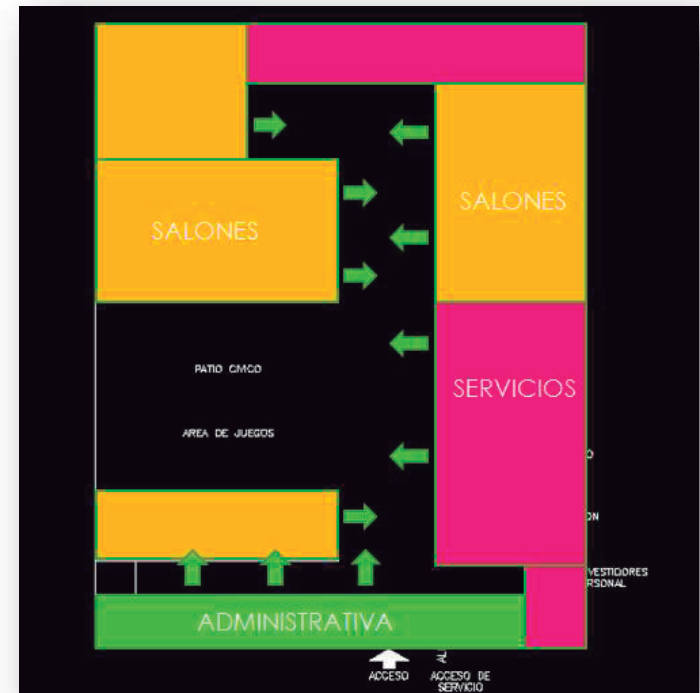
Croquis de la planta de conjunto de Estancia Infantil La Tinita. Señalando las zonas con las que cuenta
